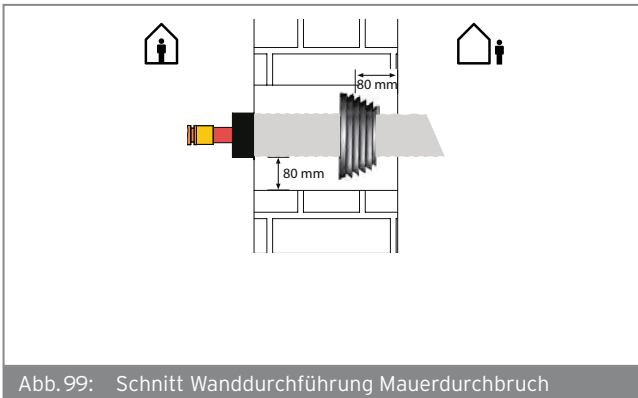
Schnitt Wanddurchführung Mauerdurchbruch
